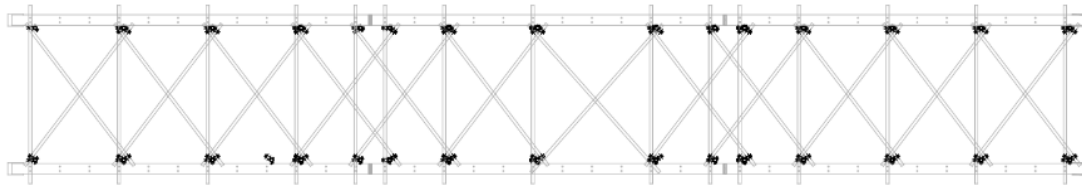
Vista da Treliça em Planta com Tubos de Contraventamento
